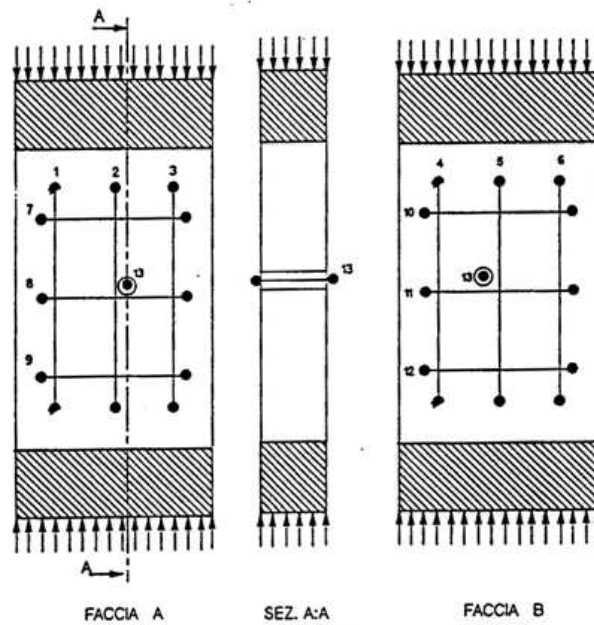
Schema di disposizione della strumentazione nelle prove a compressione diretta
